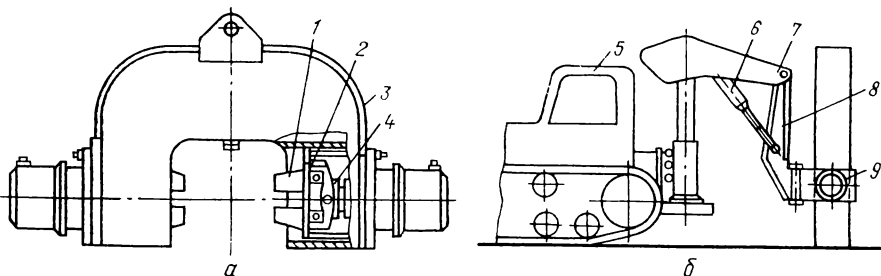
Гидросиловое устройство для разрушения железобетонных свай:
